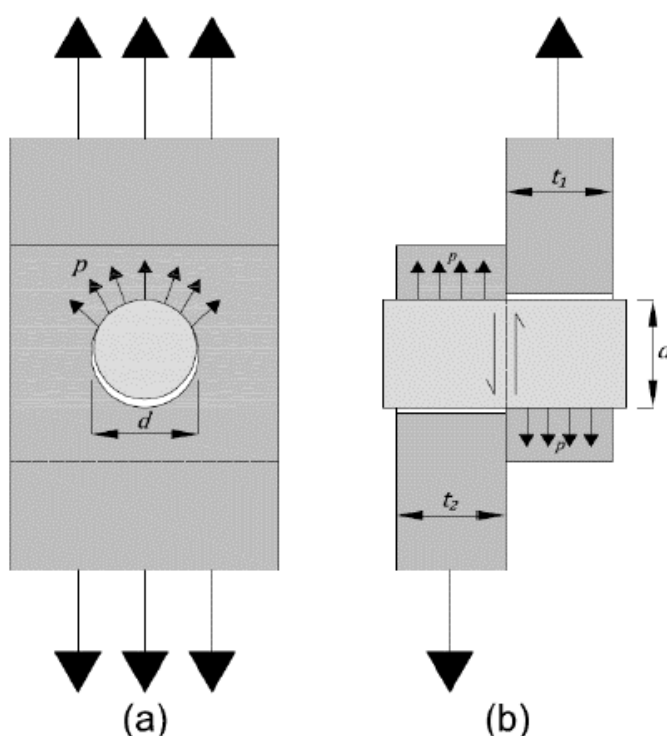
Ligação madeira-madeira em corte simples: a) vista frontal; b) vista de corte. (Negrão & Faria, 2009)
